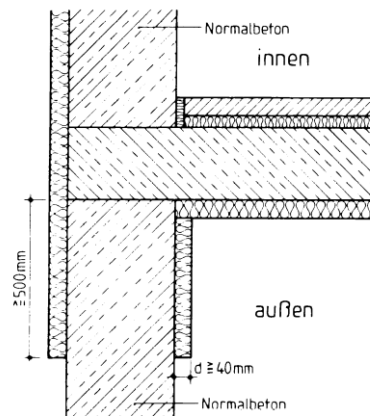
Flankierende Außendämmung einer Betonwand eines Luftgeschosses
